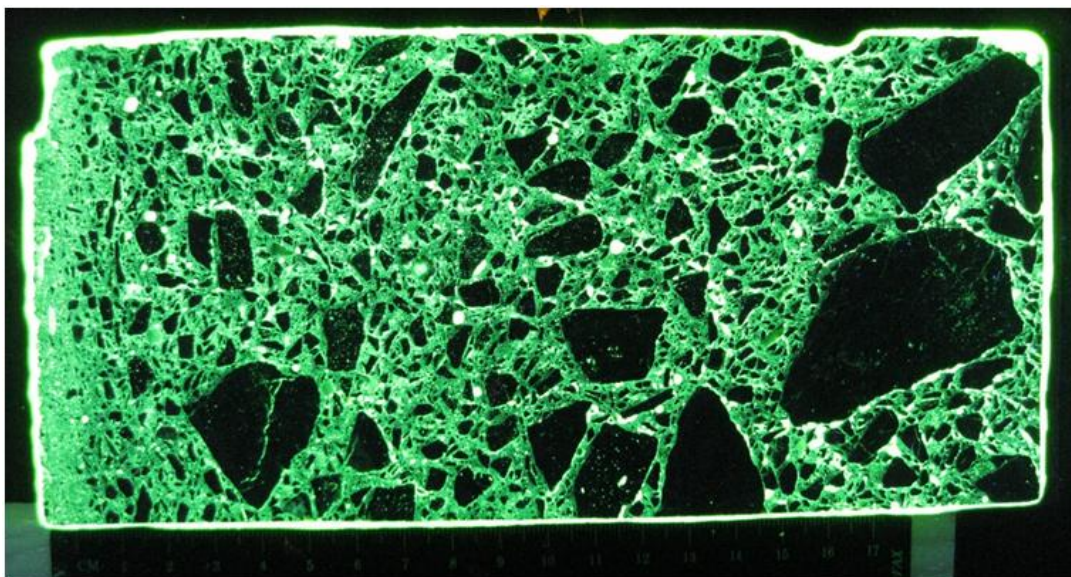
Prov G3, från Gardikfors. Planslip belyst med UV ljus. Planslipets längd är 210 mm. Betongens yta finns till vänster i bilden.
